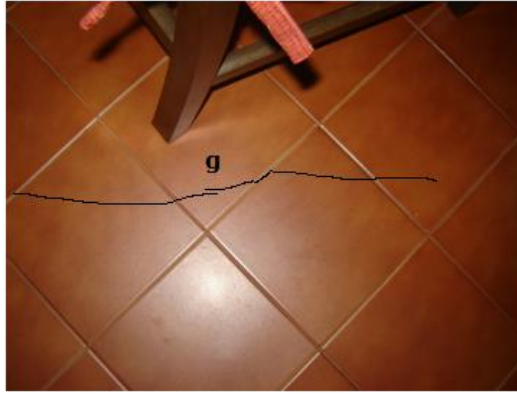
Fissuras localizadas no pavimento “g”
